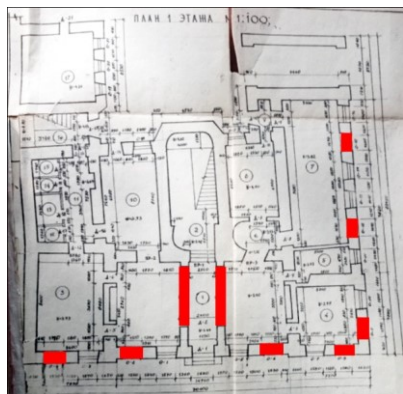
Схема плана 1-го этажа 1962 г. (до капитального ремонта 50-х гг.) [3]
